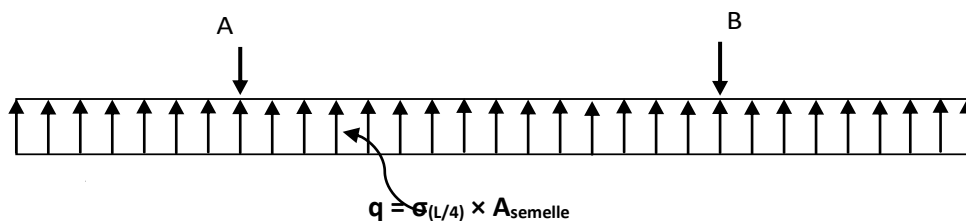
schéma statique des semelles sous poteaux.
